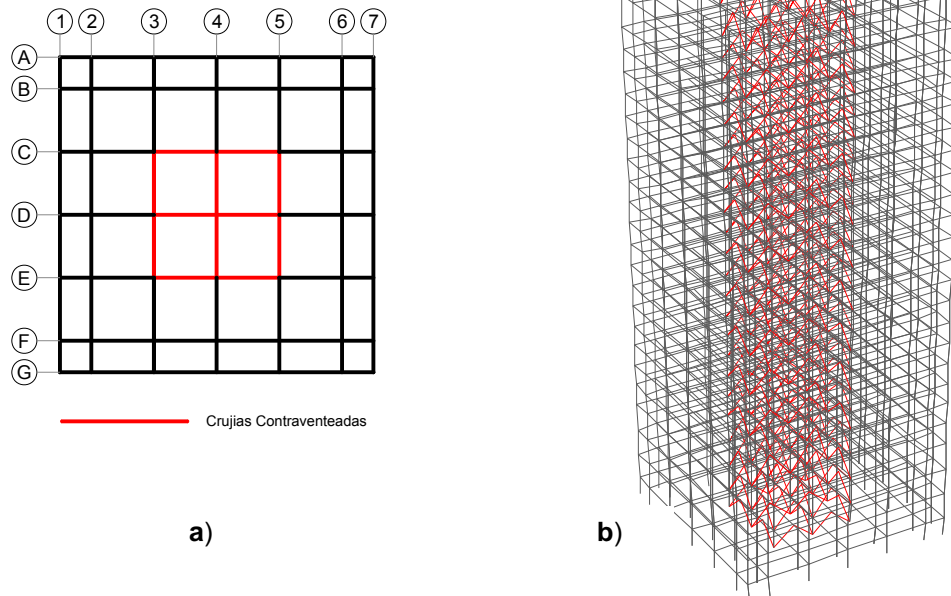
a) Planta Estructural. b) Modelo en 3D de Edificio
